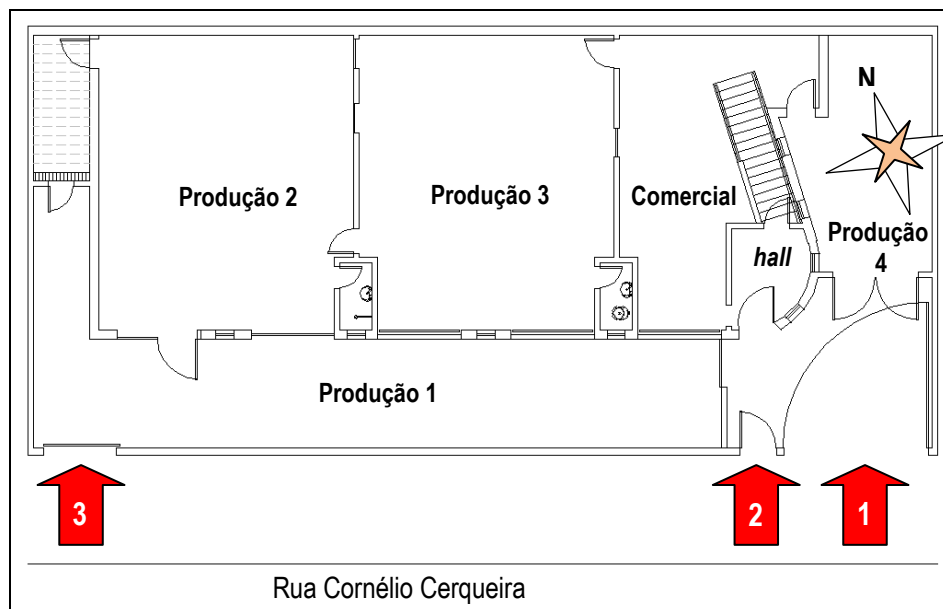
Acessos ao empreendimento (1º Pavimento)
